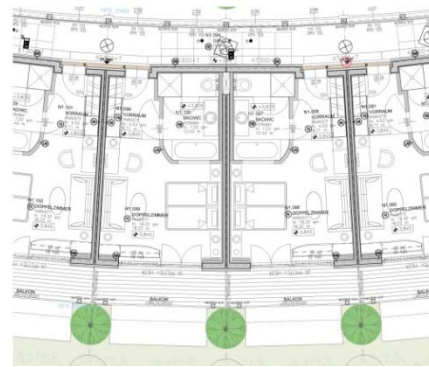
Grundriss Hotel „Die Wasnerin“
